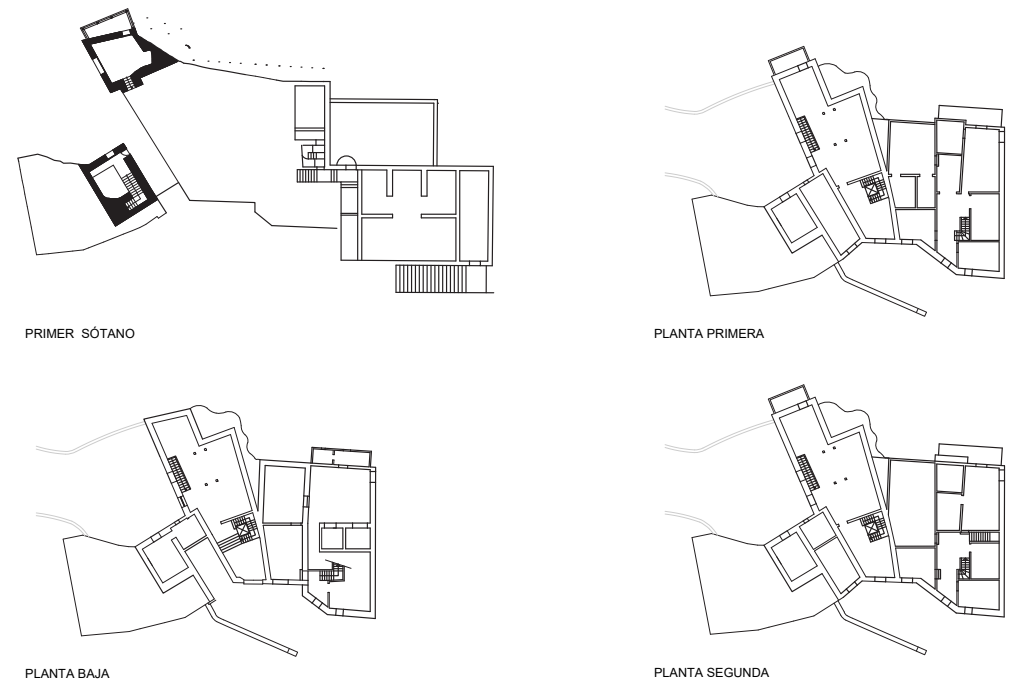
Base planimétrica planta sótano, baja, primera y segunda de las Casas Colgadas como arquitectura doméstica. Fuente: Elaboración por el autor
